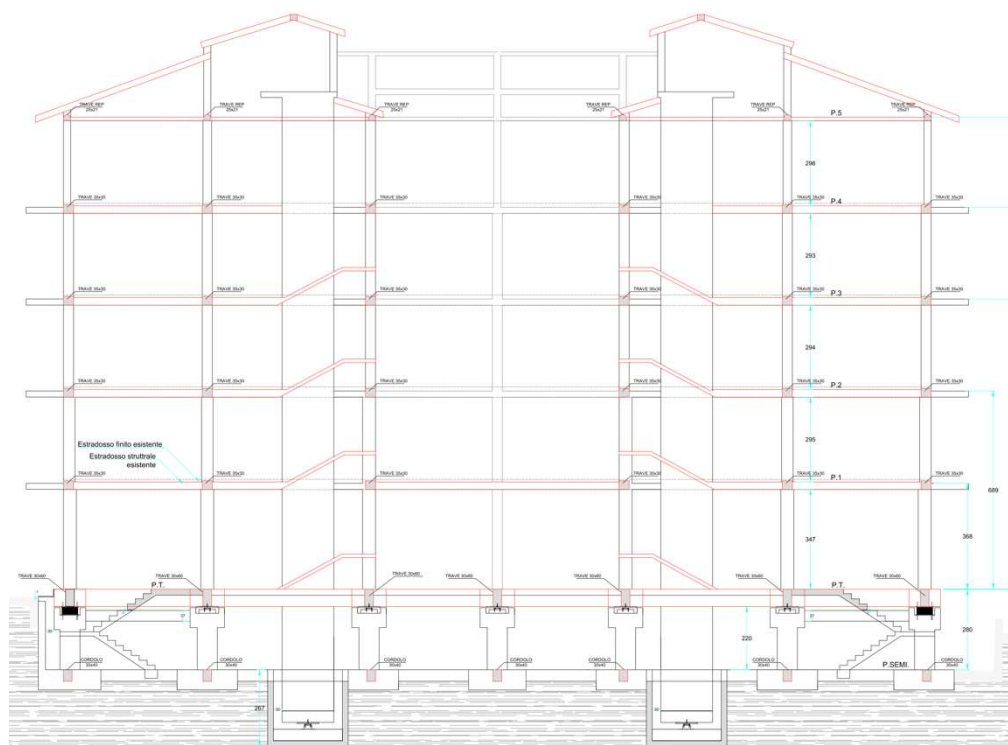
Carpenteria dell'edificio nello stato di progetto. Sezione B-B (scala 1:50).
